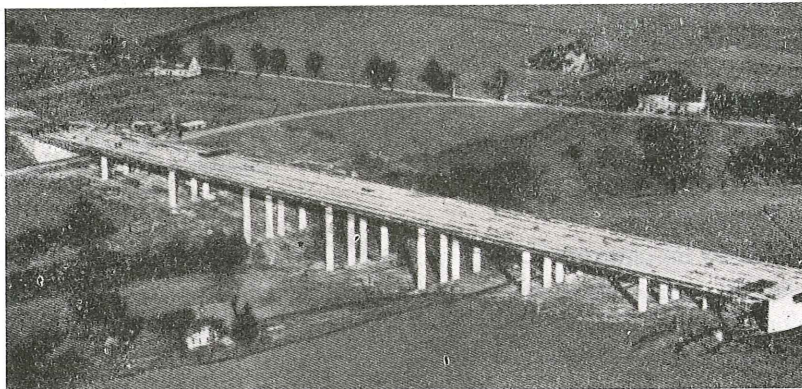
Puente de Liedbachtal. Consta de 8 tramos de 37,5 m de luz y una anchura total de tablero de 27 m. Está formado por seis vigas principales, de 1,50 m de canto; cuatro de ellas van sobre apoyos aislados y las otras dos, flotantes, apoyadas en diafragmas transversales.
